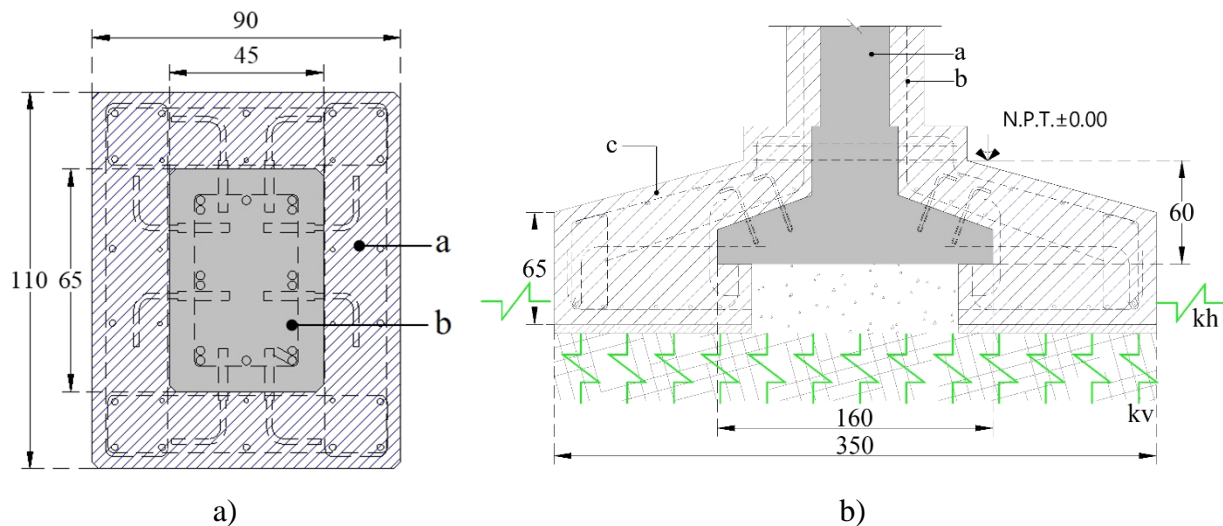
Detalhes de encamisamento em pilares e fundação; a) encamisamento de pilar de concreto armado existente; b) encamisamento de pilar de concreto armado existente; onde: a = reforço de pilar por meio de encamisamento de concreto armado, b = pilar de concreto armado existente, c = reforço de fundação à base de sapatas corridas. Cotas em cm.
